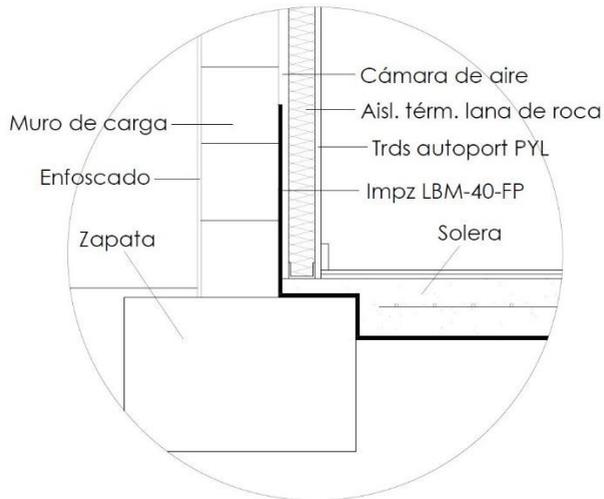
Detalle propuesta trasdosado. 2022. Fuente Propia
